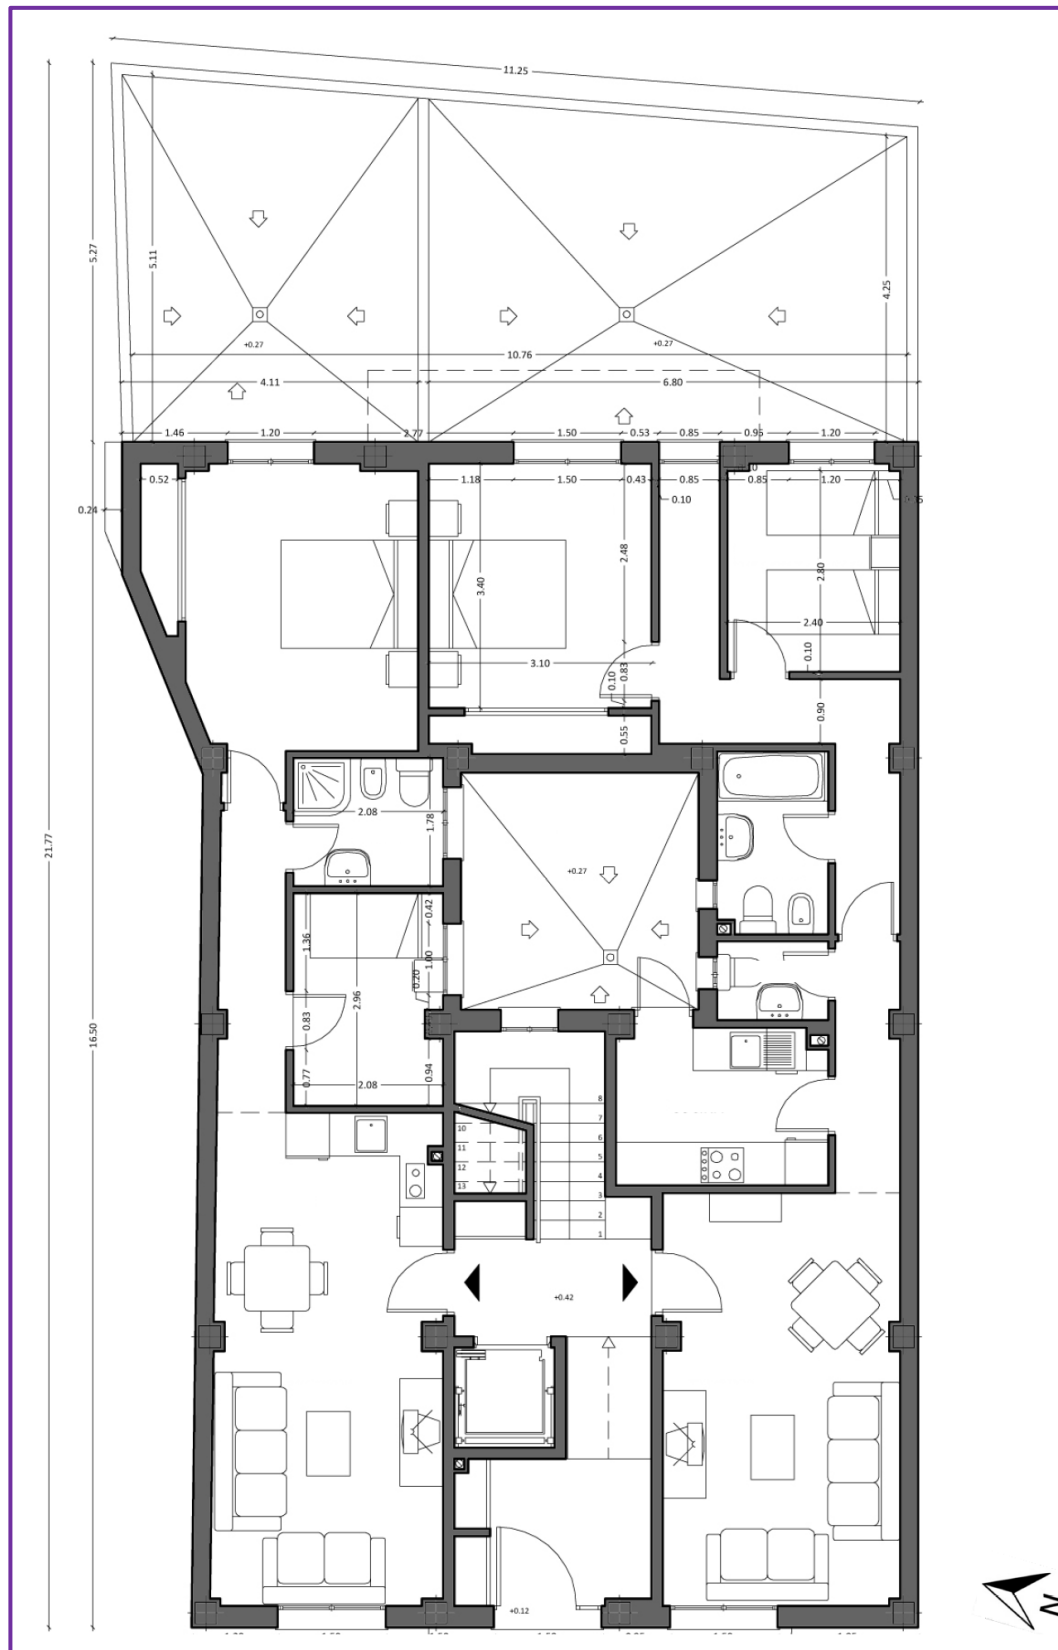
Plano de planta baja (Fig.4.8 de Facchini, 2014)
